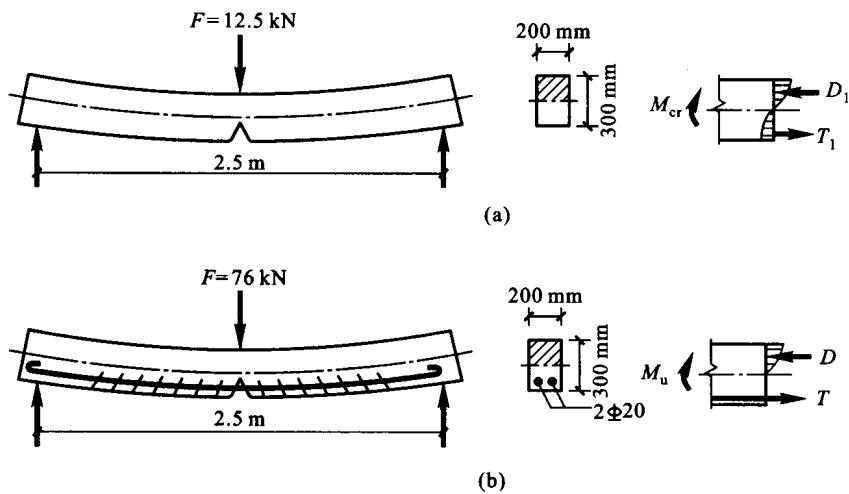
钢筋混凝土梁与素混凝土梁的比较
